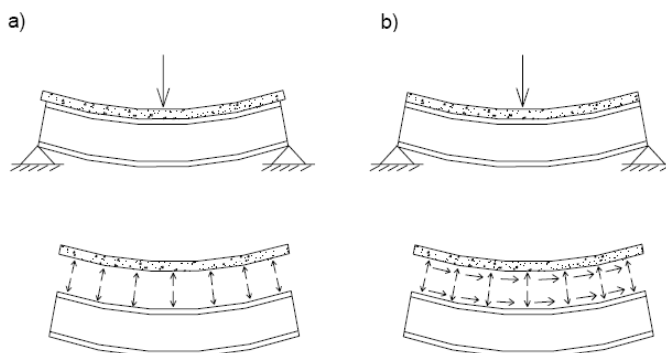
(a) Comportamento Isolado da viga e da laje; (b) Acção Mista (Carvalho, P.R. *et al* 2006).
